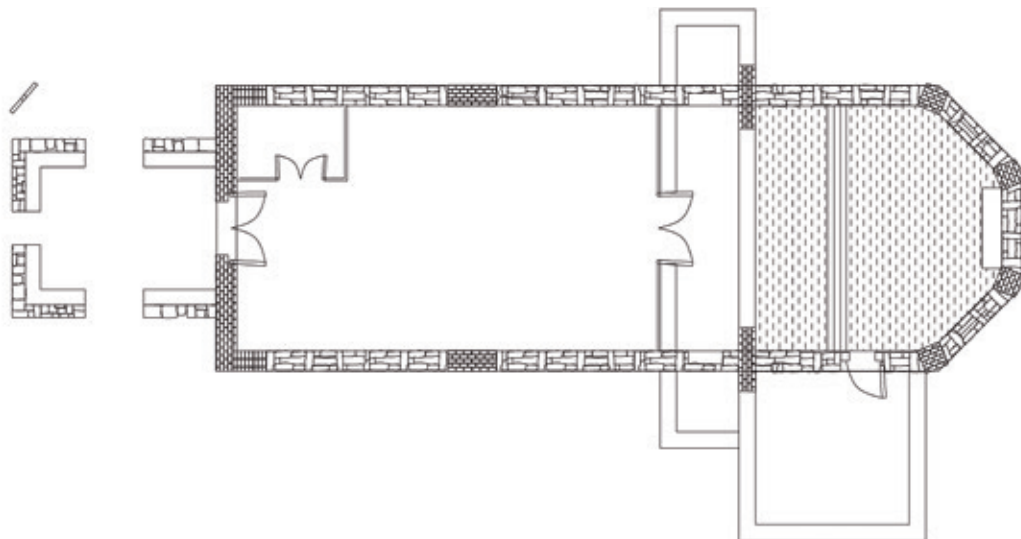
Planos de la iglesia de Tunjuelo construida con muros de piedra rafada con ladrillo. Planta general²⁵.
